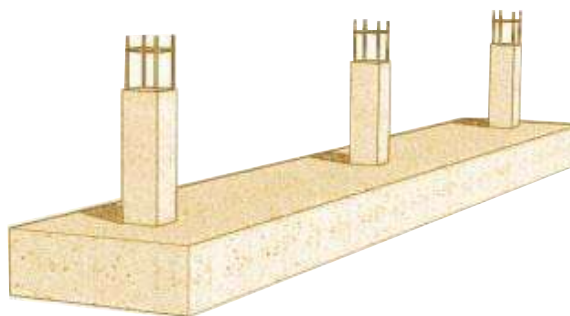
Zapata corrida propuesta para el edificio de dormitorios.
